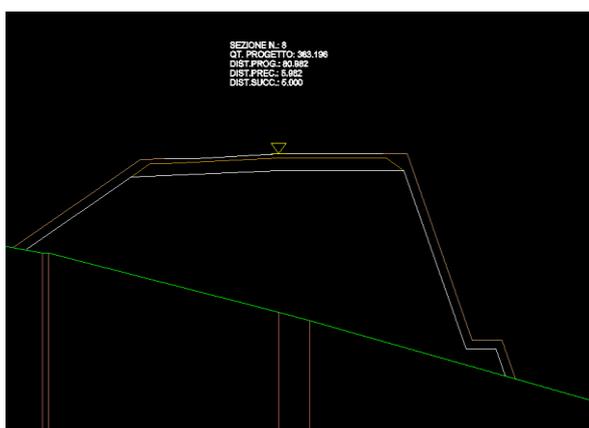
Dettaglio sezione 8 - terre rinforzate su scarpata in destra
